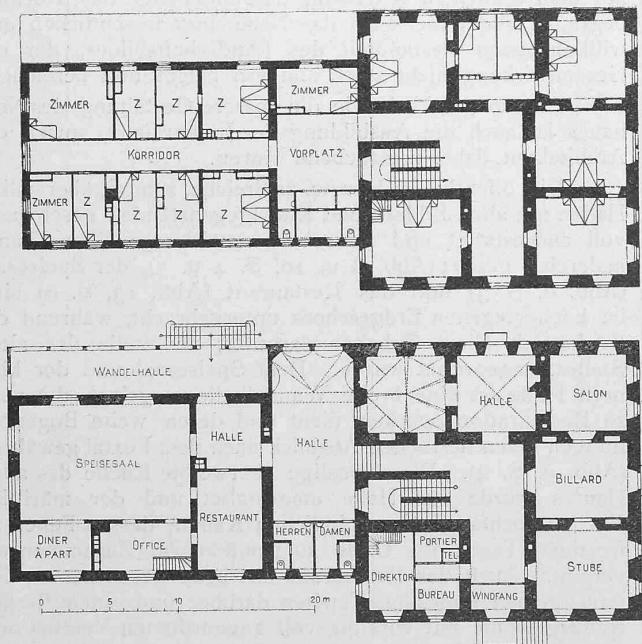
, 4 und 5. Grundrisse vom Erdgeschoss und ersten Obergeschoss samt Querschnitt. — Masstab 1:500.
